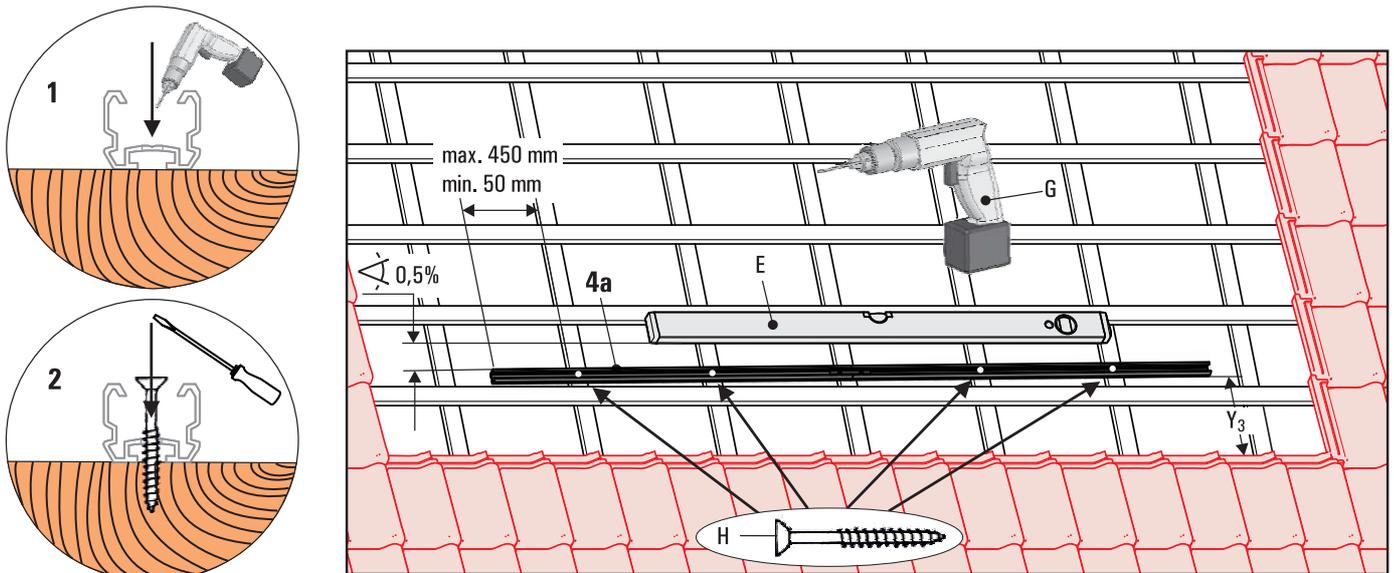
Disporre la guida del profilo di montaggio inferiore (4a) e fissare con le viti oer cinoesati (H) all'armatura del tetto.
